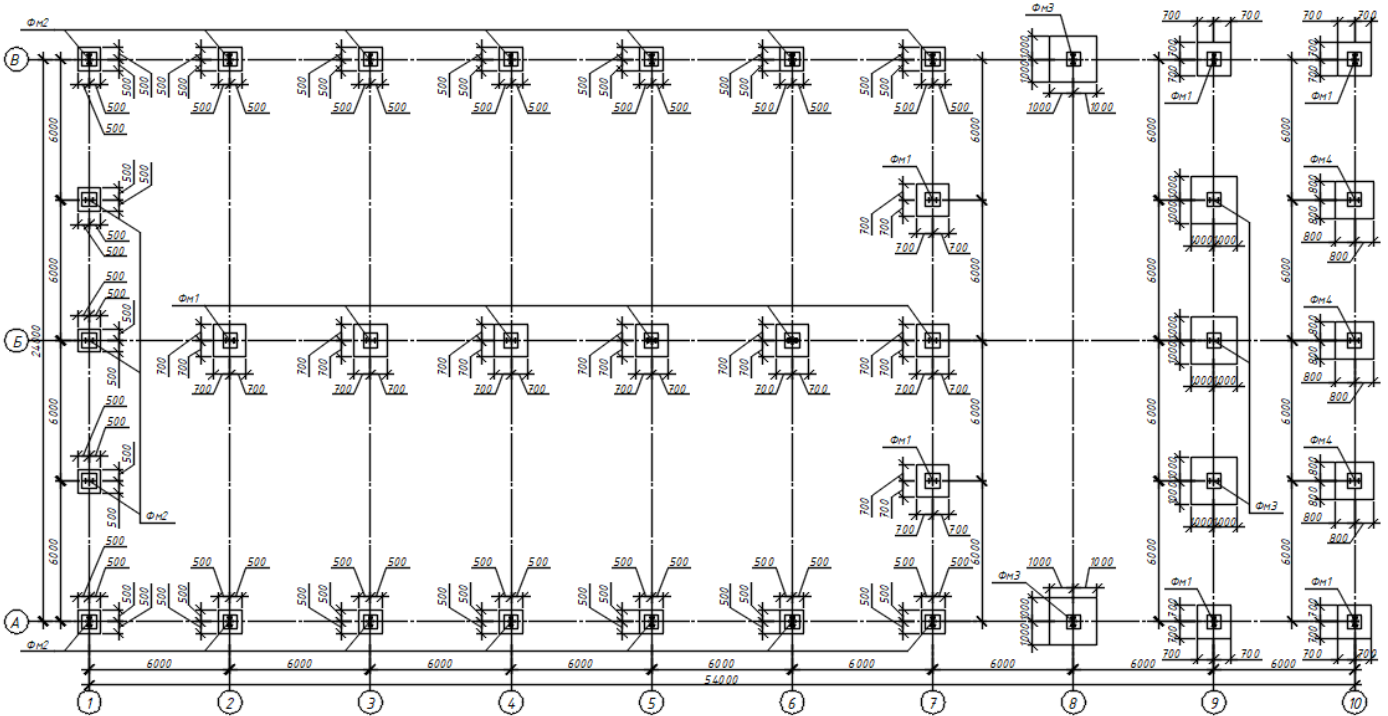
Попередній розподіл фундаментів будівлі на типи
